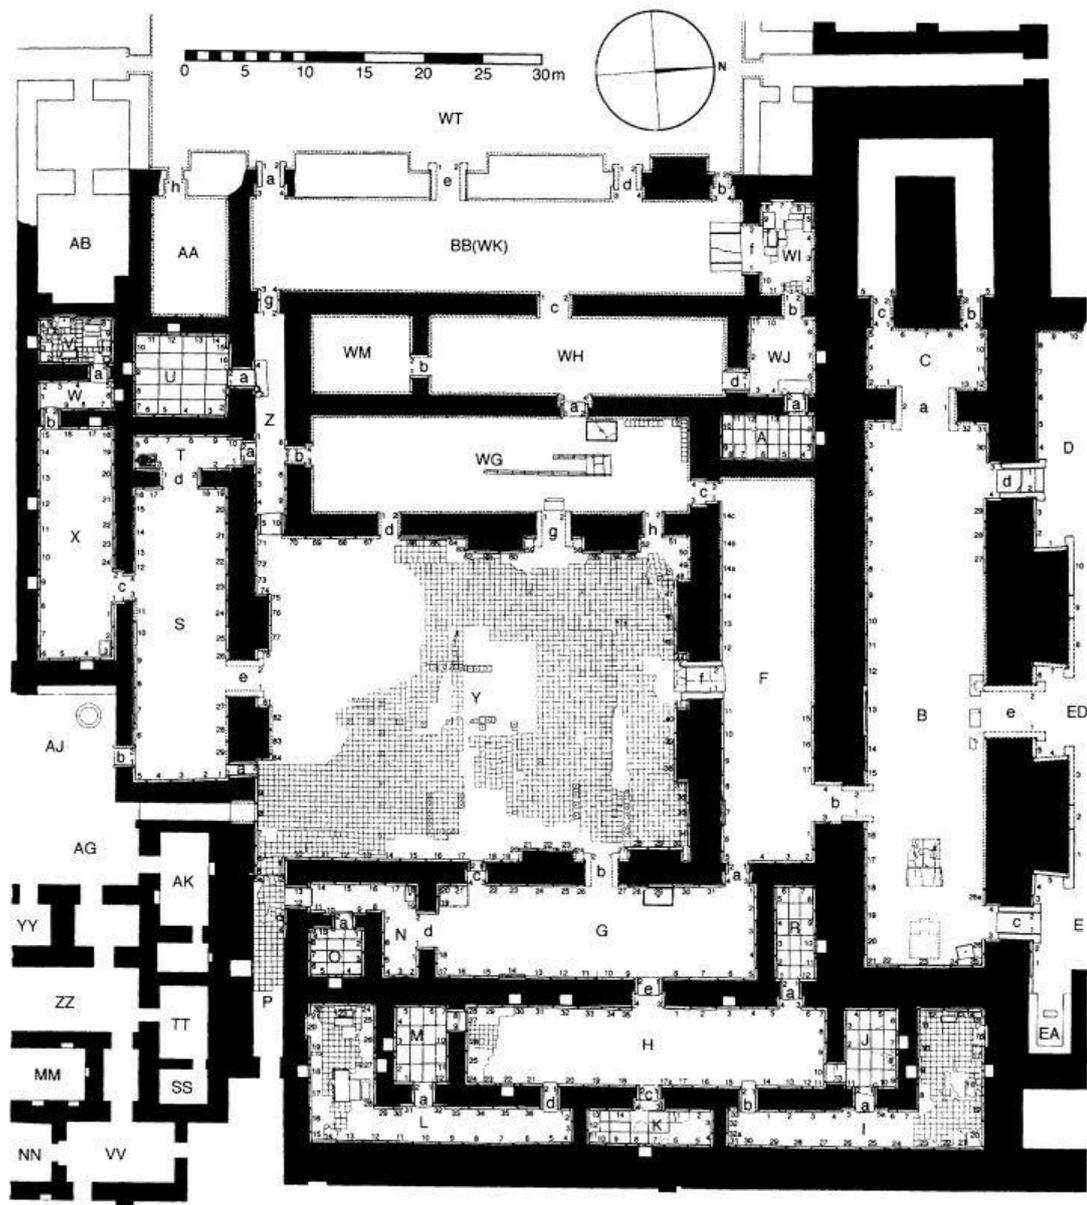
Planta dos apartamentos de Estado do Palácio Noroeste.
